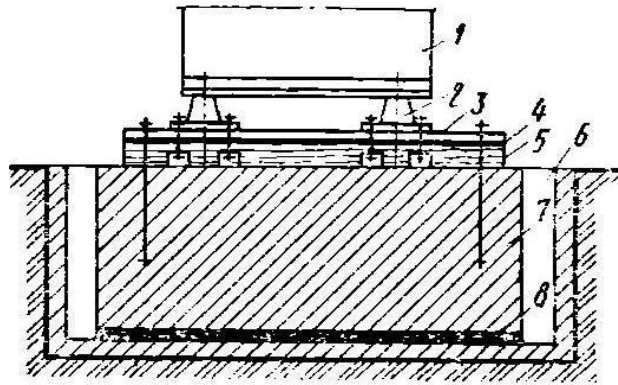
Установка вентилятора на віброізолюючому фундаменті:
